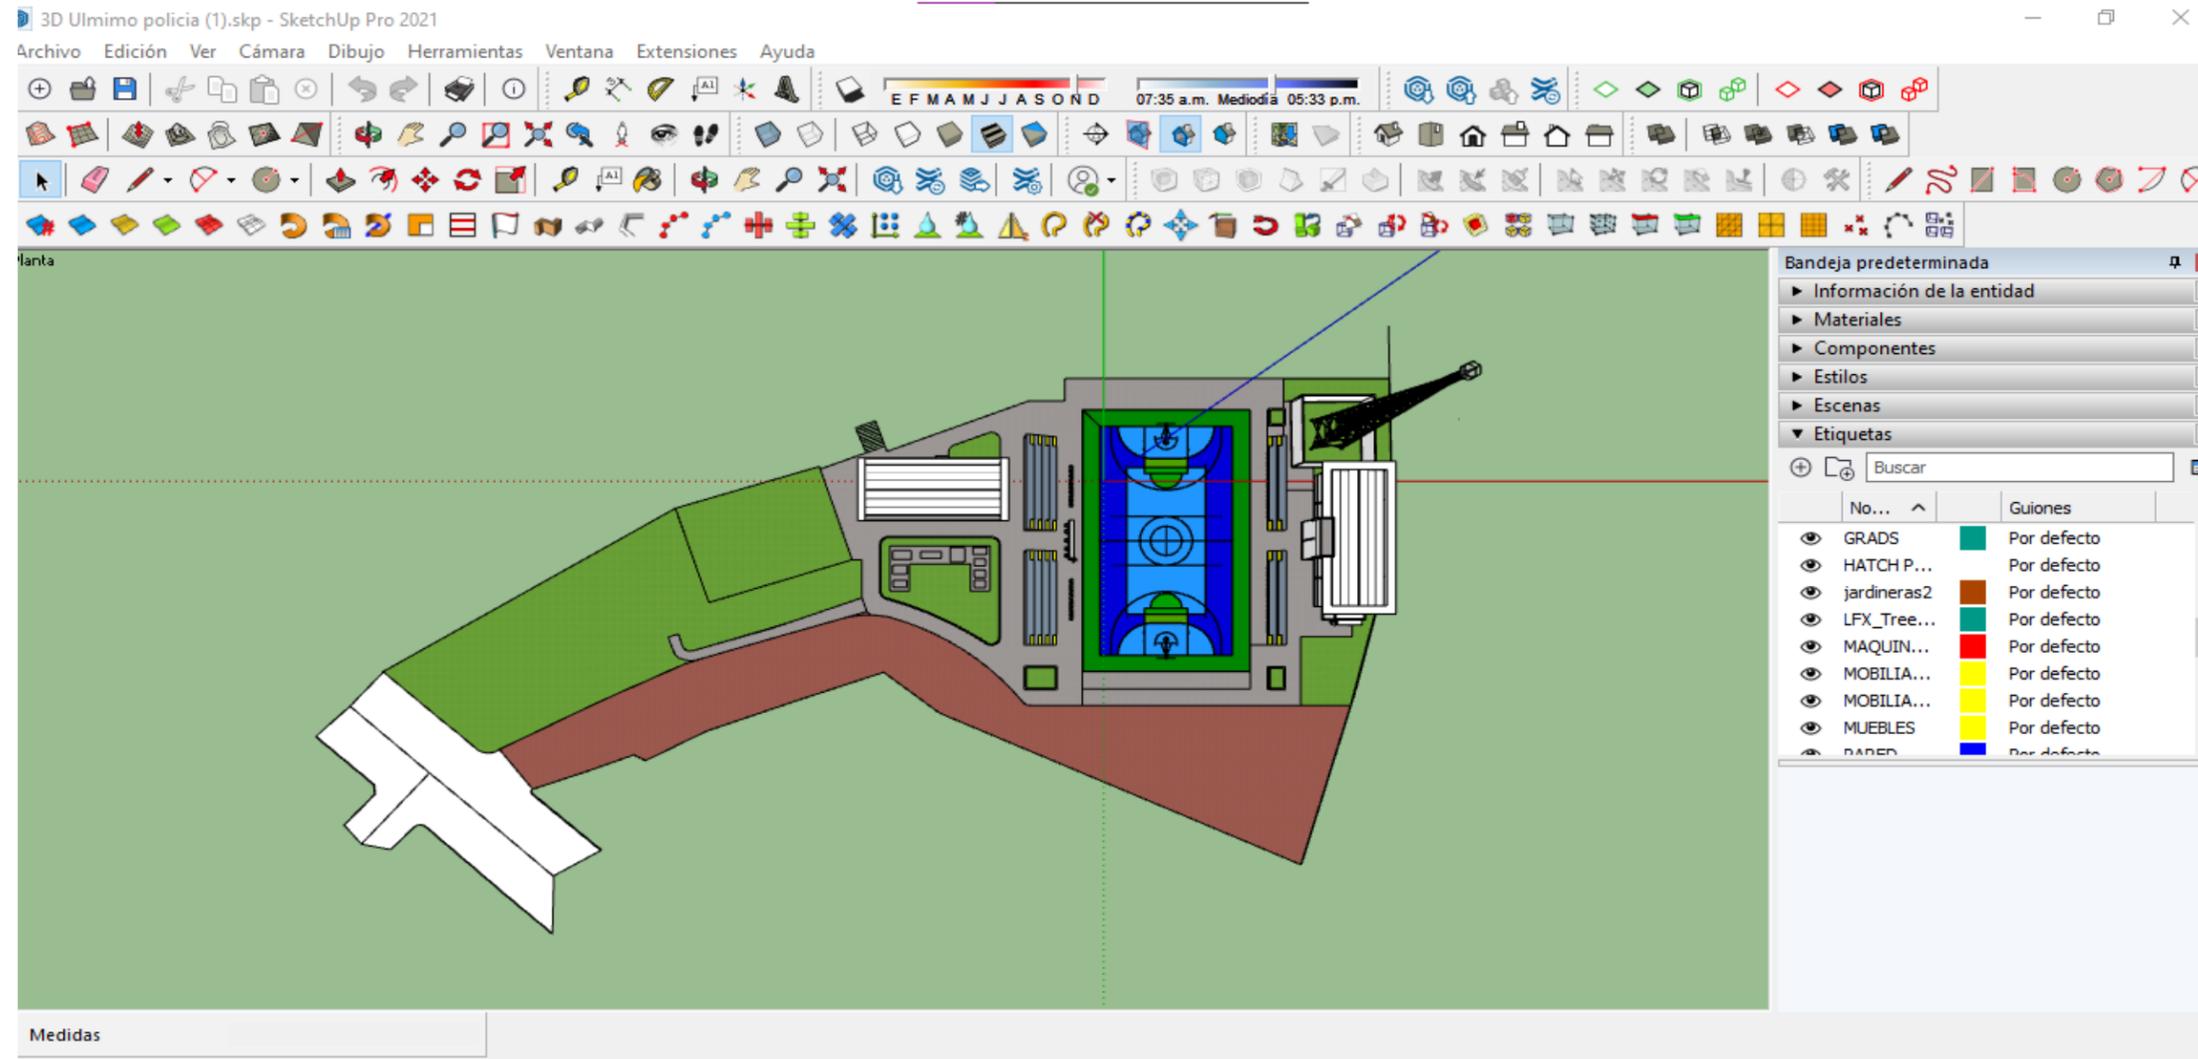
Levantamiento de 3D del conjunto de Cancha Multiusos Faustino Ruiz, elaborada por la Practicante
